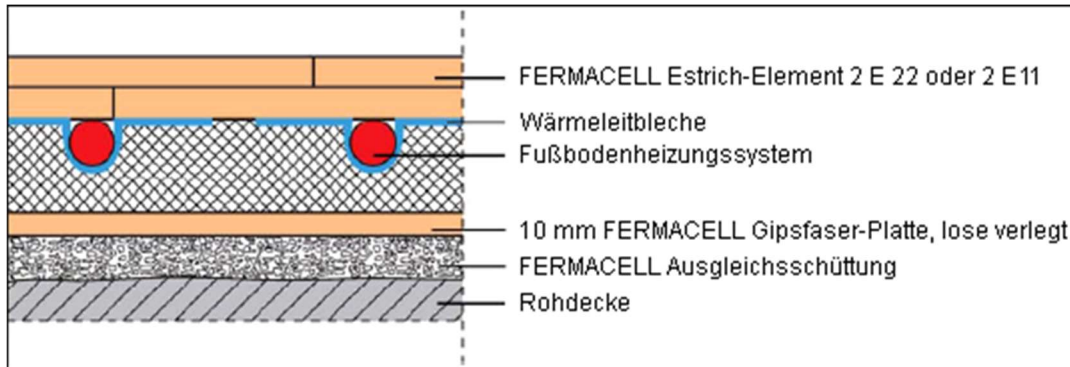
Aufbau einer Rohfußbodenheizung in Trockenverlegung⁷³
